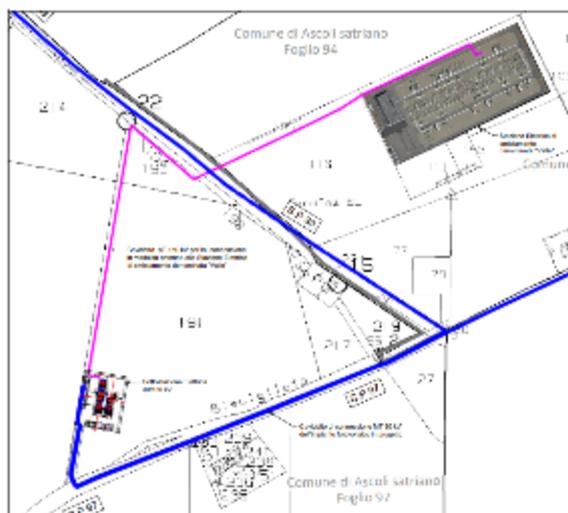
Particolare SSE AT/MT e SSE Terna "Valle" su base catastale (in rosa il cavidotto AT) (stralcio elaborato 033\_ASC-CIV-TAV-033\_01 - Planimetria degli impianti di utente e di RTN-signed-signed)
